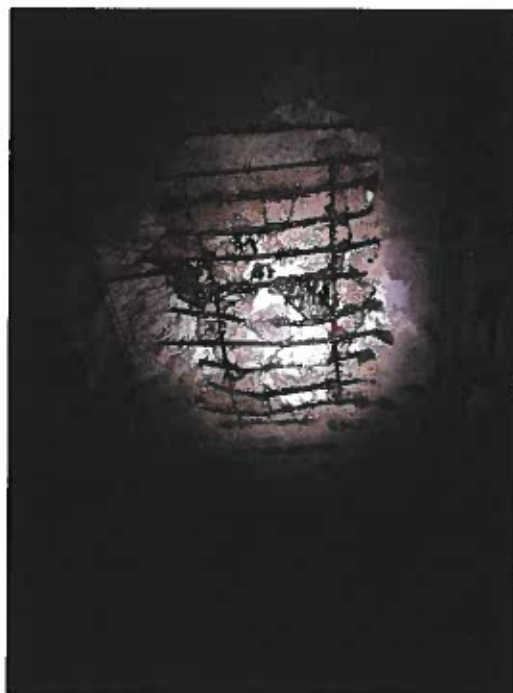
Degradări ale betonului din grinzi pe toată lungimea acestora: beton complet dislocat, măcinat, armături longitudinale și transversale la vedere, corodate, cu reducere severă a secțiunii, exfoliate, deformat, unele fără contact cu betonul, armături rupte. Grinda și-a pierdut forma geometrică inițială. Infiltrații și carbonatări la intradosul plăcilor de planșeu
